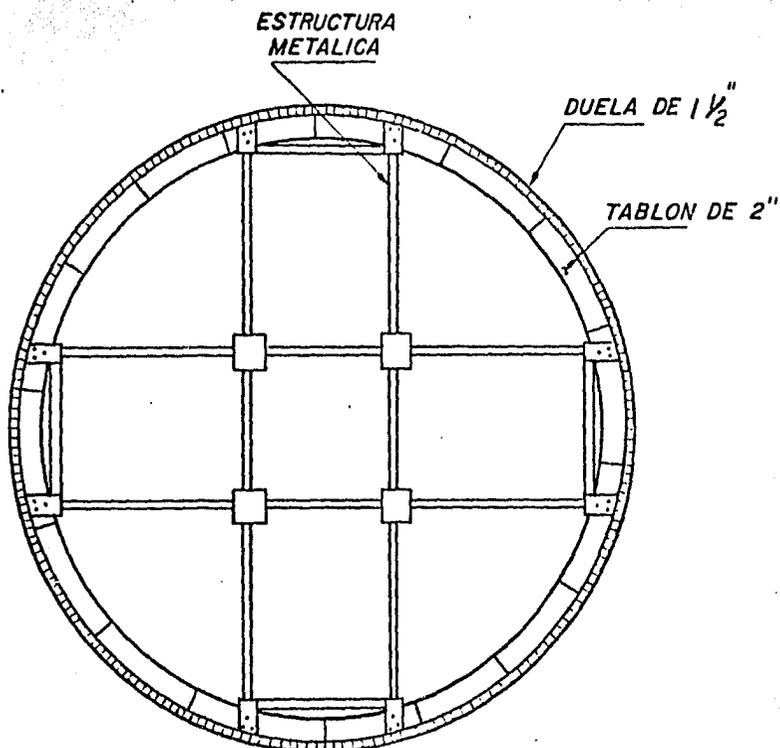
VISTA EN PLANTA DE LA CIMBRA CON SU ESTRUCTURA
